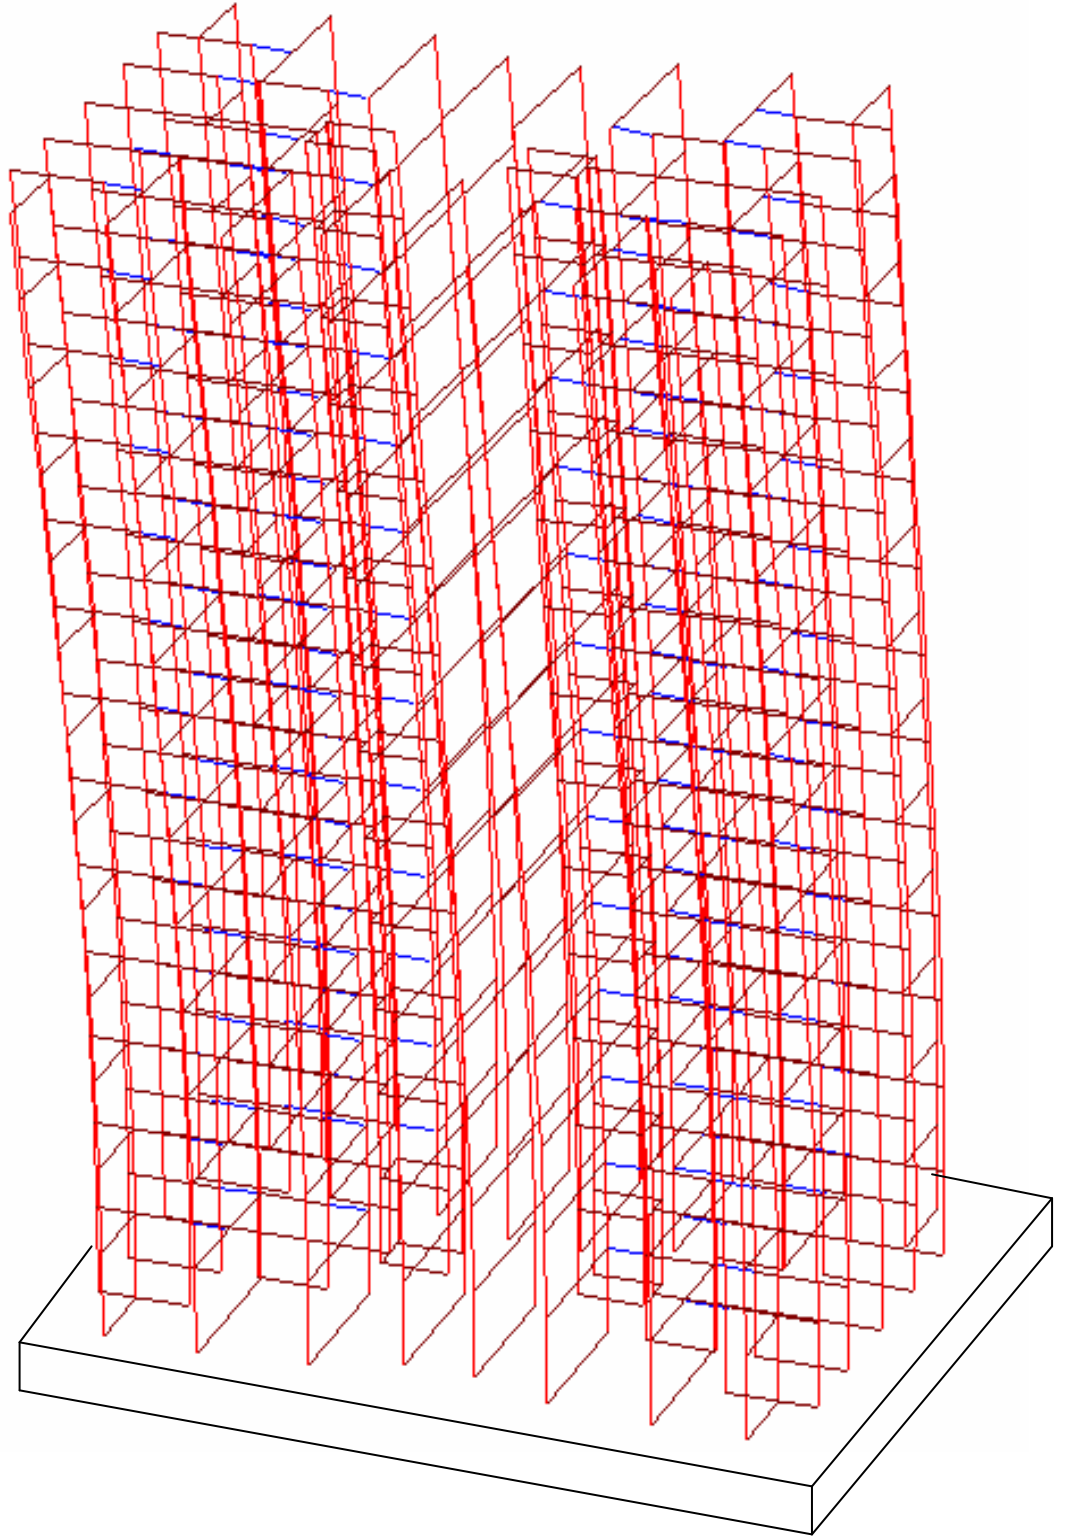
Bims betonlu binanın 1. katının üç boyutlu gösterimi.
